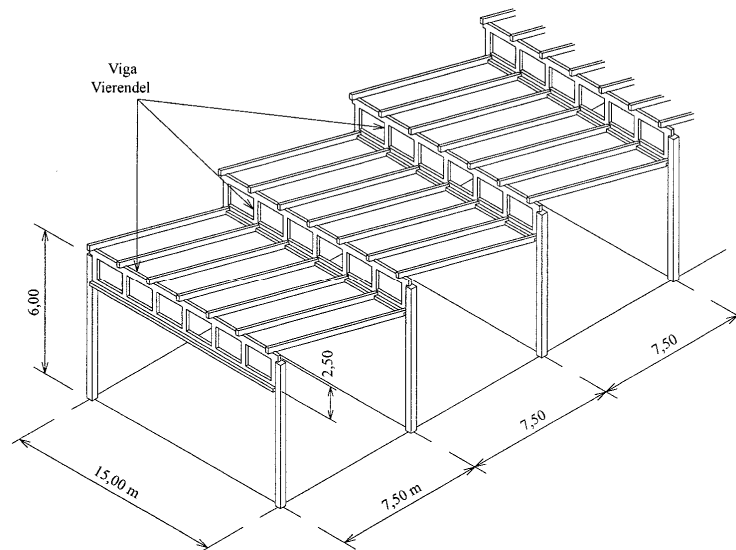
Sistema estrutural com elementos em forma de viga Vierendel.
